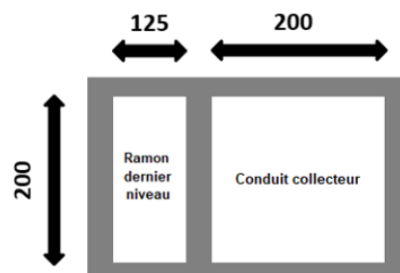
Schéma en coupe d'un conduit de fumée Shunt sans conduit de ventilation dédié
